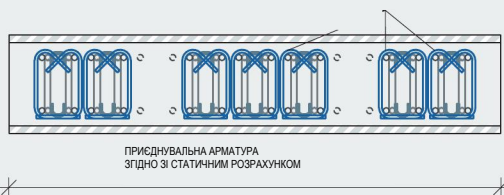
Армування на об'єкті, для SL-TKM та SL-TKA (план і розріз А)
